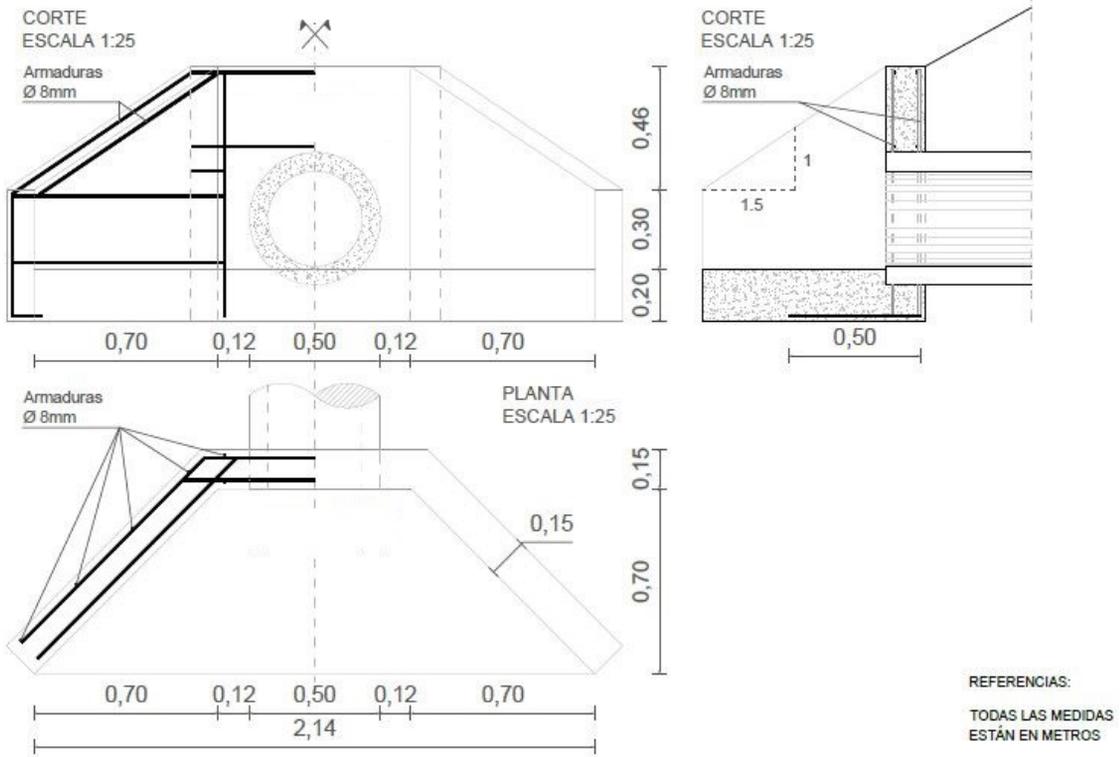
Plano de cabeceras de hormigón armado in situ.
